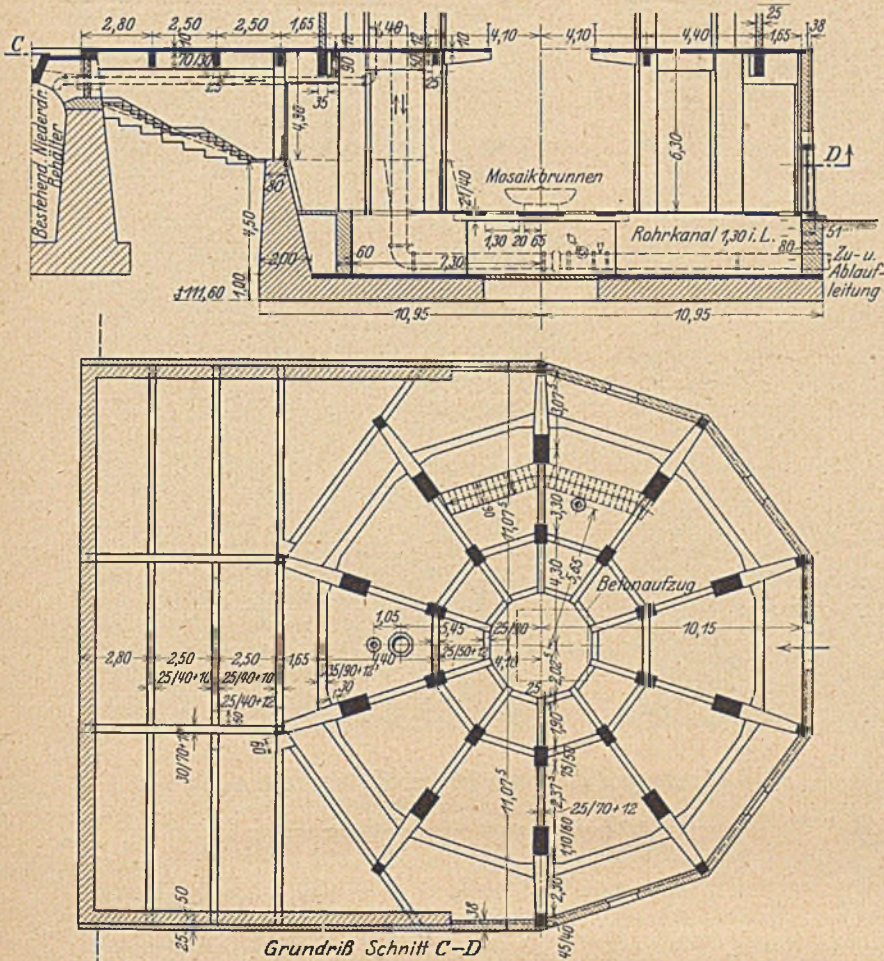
Erdgeschoß-Grundriß und -Schnitt mit Erdbehälter.
